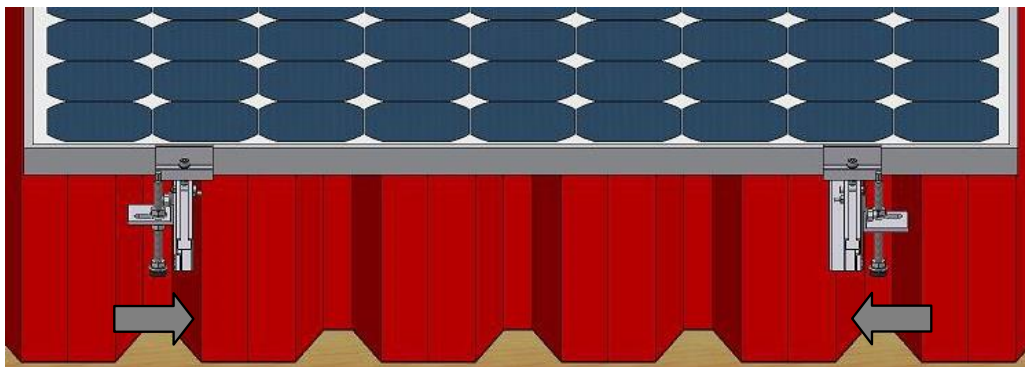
Montierte Stockschraube mit „Universalverbinder“
